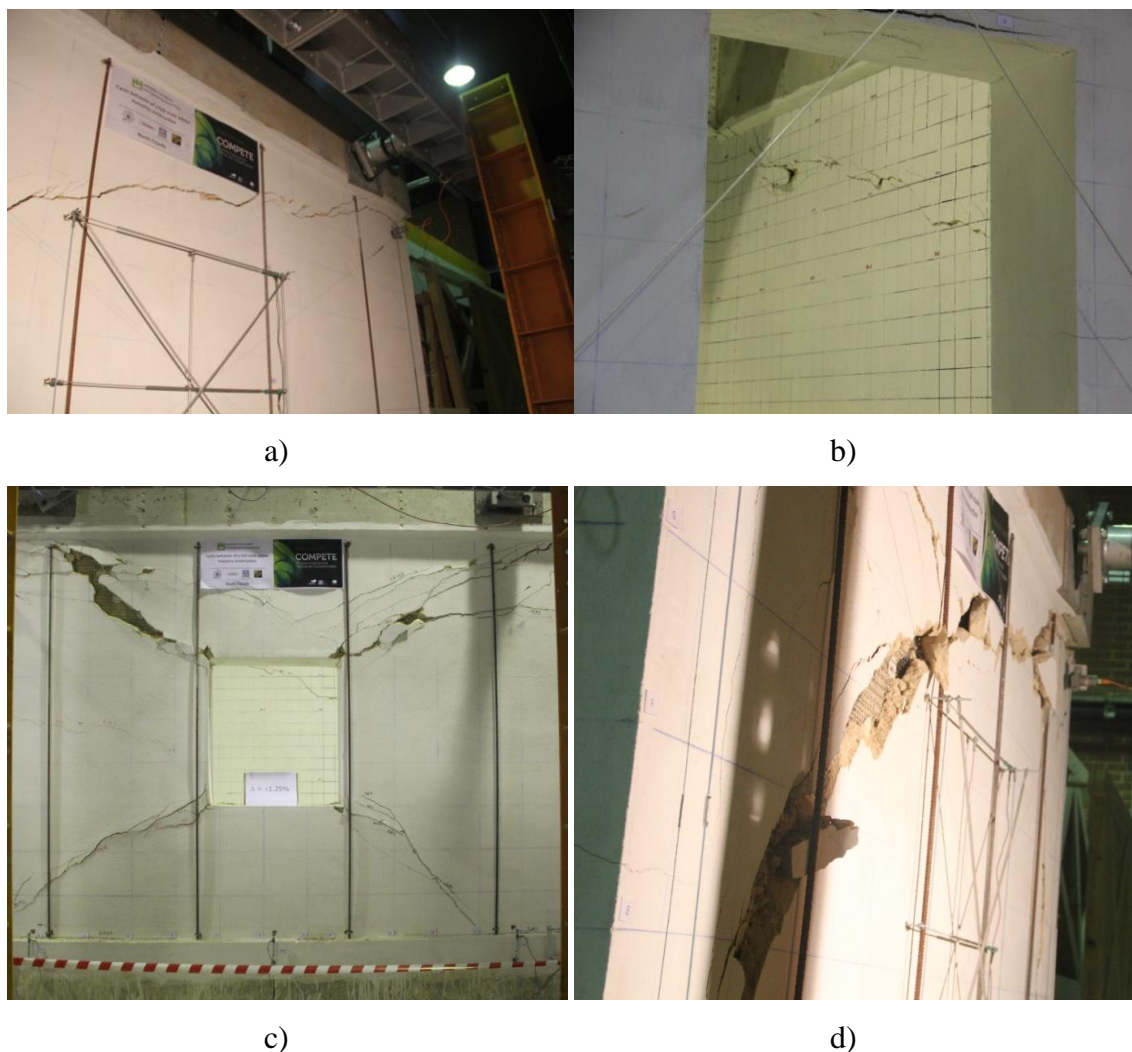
a) Fissura diagonal na face exterior da parede Norte após o nível de *drift* de 1,250% b) Fissura diagonal na face interior da parede Norte após o nível de *drift* de 1,250% c) Danos da fachada Sul após o nível de *drift* de 1,250% d) Danos da fachada Norte após nível de *drift* de 1,500%
